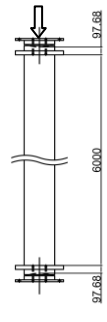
載荷試験の状況 図 3-1 載荷試験図
